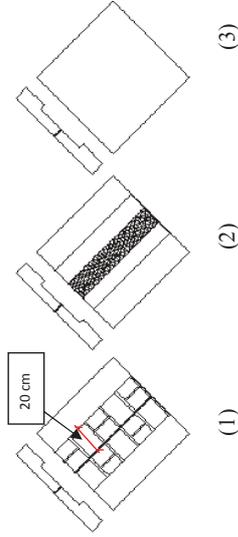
Esquema de correção de fissuras de abertura superior a 1,0 mm: abertura do revestimento (20 cm para cada lado); aplicação de selante e fixação de bandagem (15 cm para cada lado); execução do revestimento.
